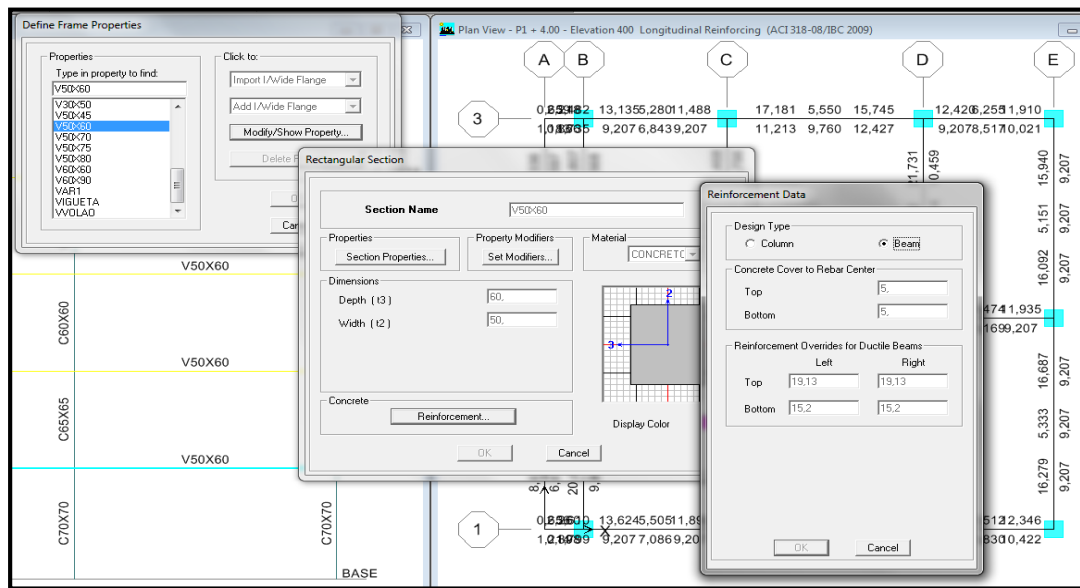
Secciones de Viga de Acuerdo al tipo de Armado. Nivel 2. Edificio Módulo1
